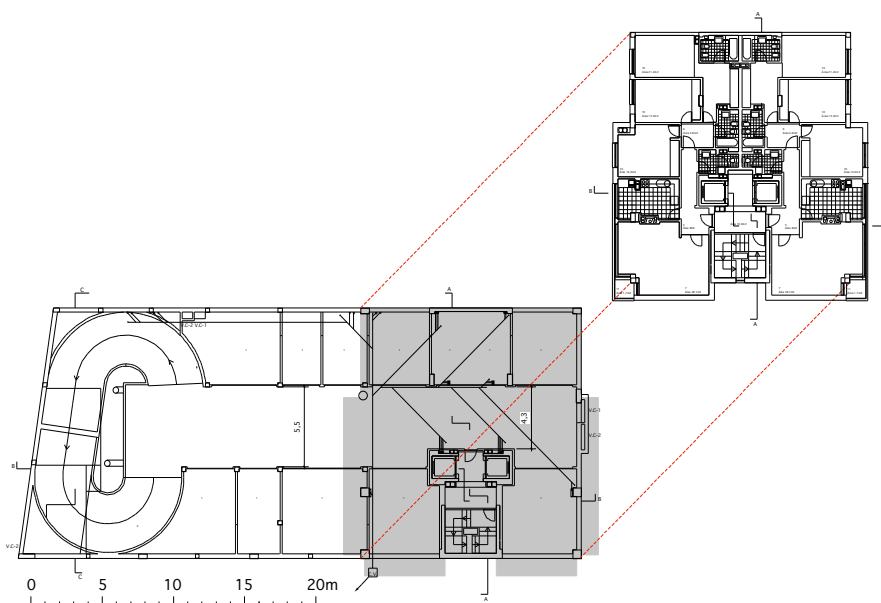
Planta da 1ª cave e Planta do Andar-tipo
